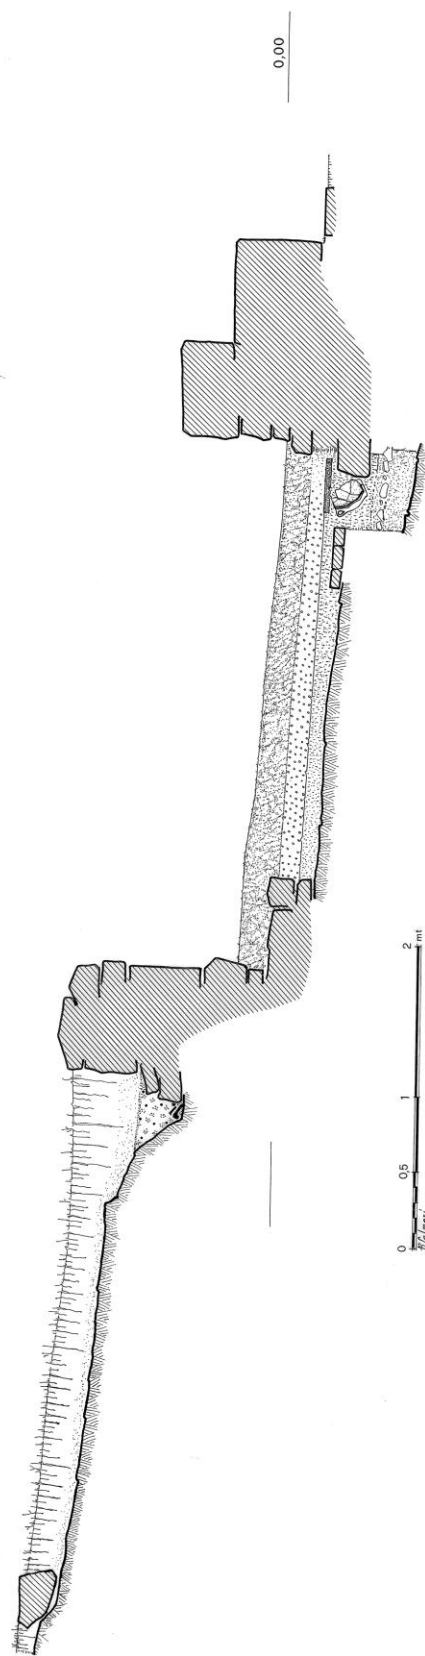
Area del Bastione – Pianta generale
